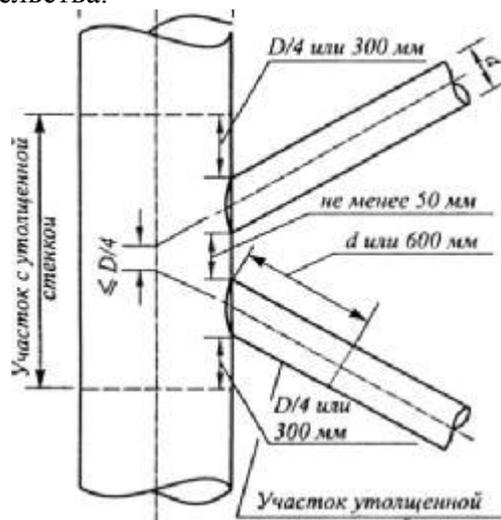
Схема узла с утолщением стенок элементов стенкой
